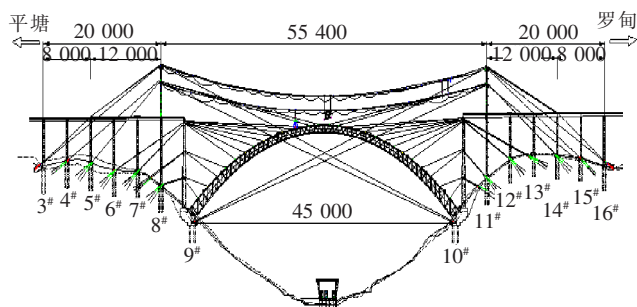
缆索吊装斜拉扣挂系统立面布置示意图(单位:cm)
